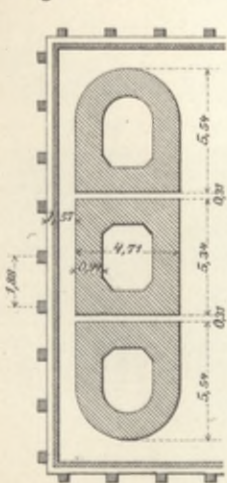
Grundrissanordnung für getrennte Brunnen.
